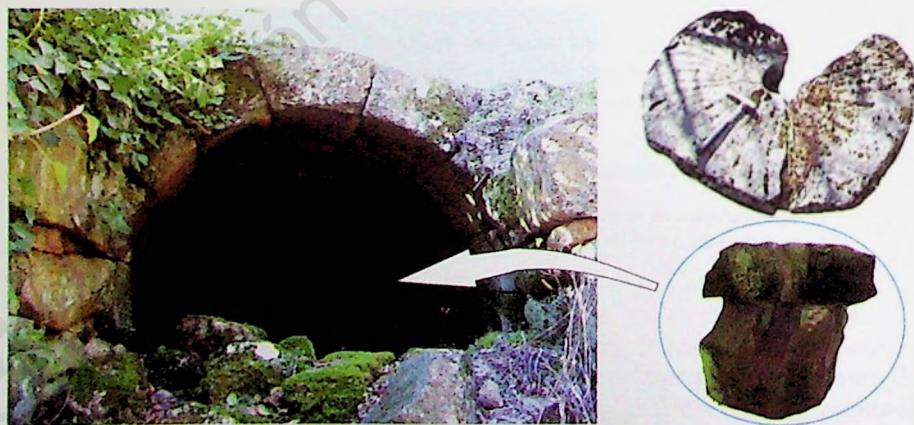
a. Vista frontal del cárcavo del molino Roto con detalle de la cacera de piedra. En la parte superior derecha puede observarse detalle de una piedra monolítica granítica que se ha conservado.
